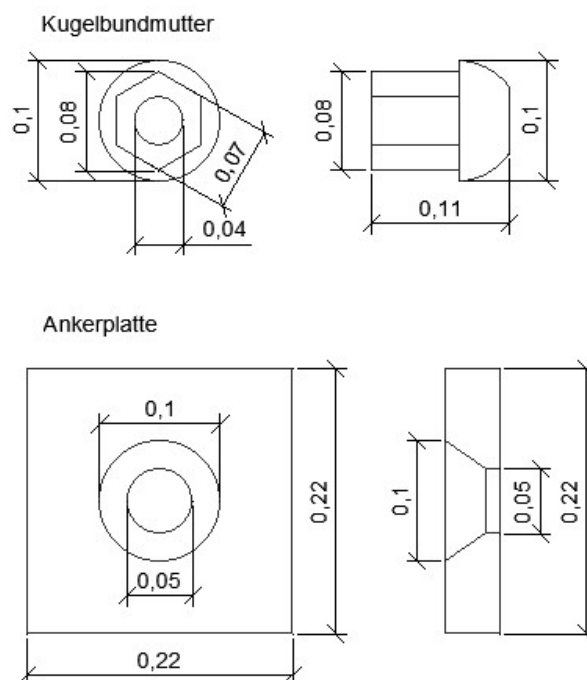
Detaildarstellung Anschlussteile (Abmessungen in m)
